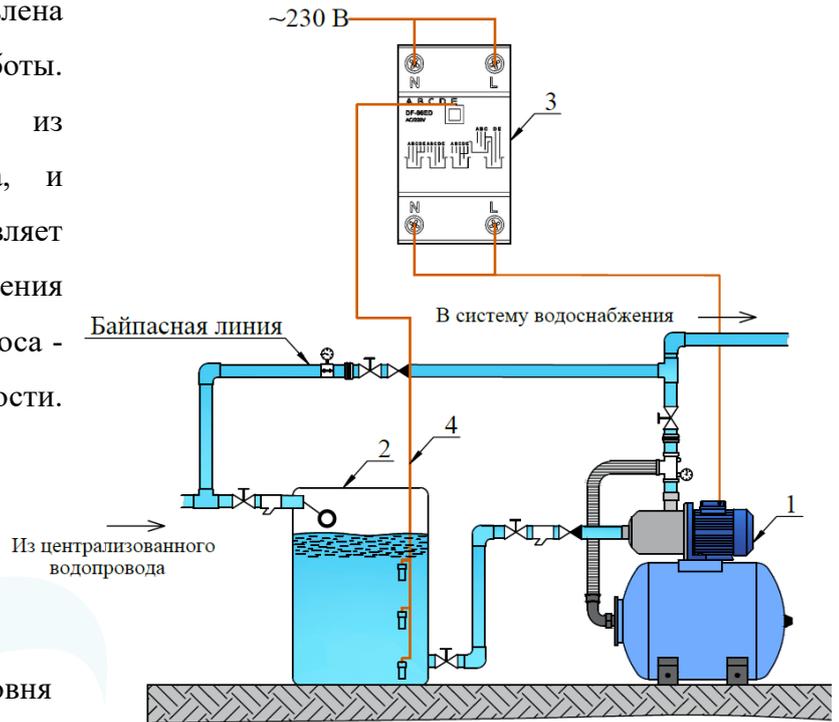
Водоснабжение здания из центрального водопровода
